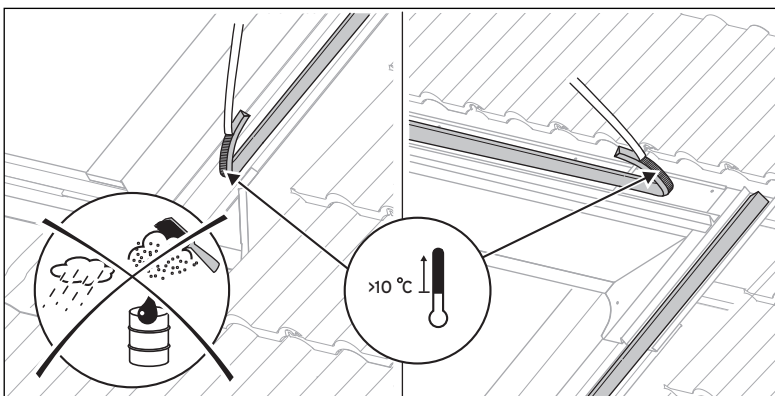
Installation de la pièce d'étanchéité en mousse
